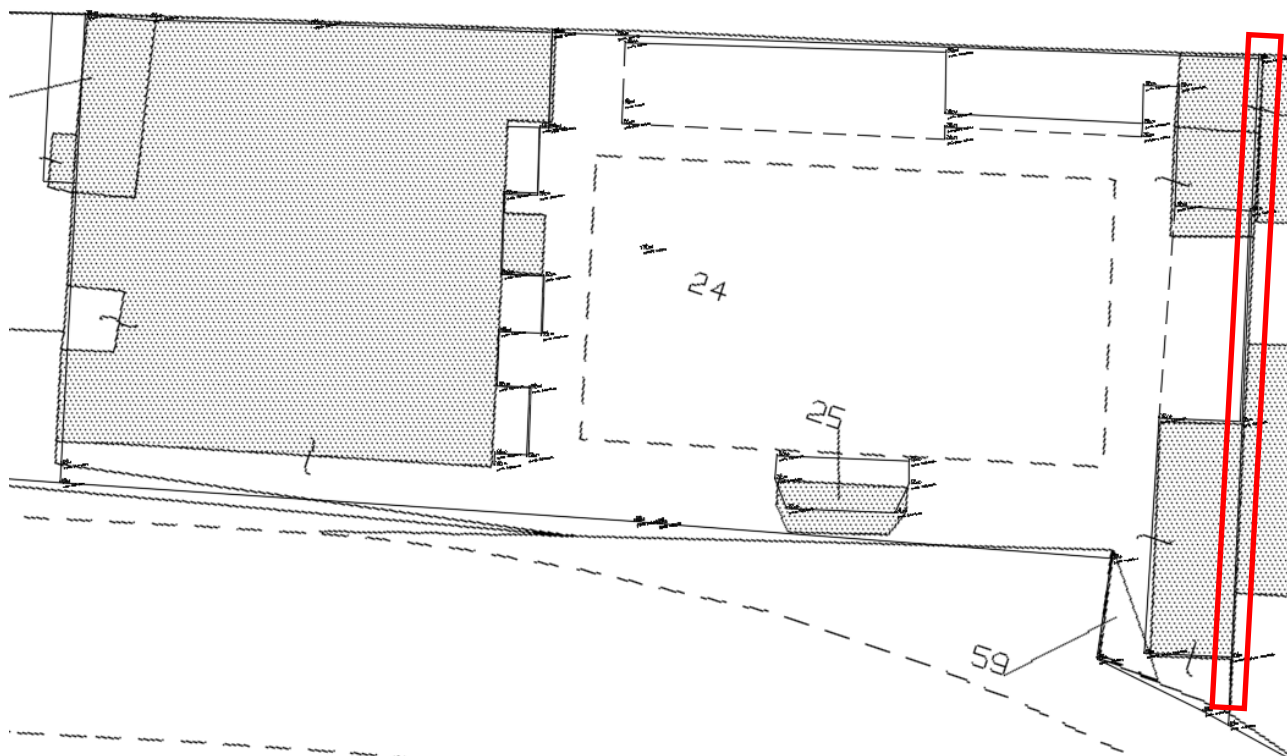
Pianta dell'area oggetto di intervento con indicazione della Muratura perimetrale adiacente ai fabbricati N°4 e N°5 da indagare più approfonditamente.
